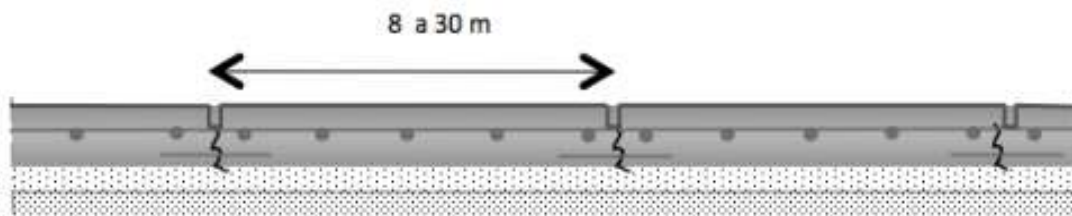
Pavimento de betão armado com juntas (elaboração própria – adaptado de Picado Santos et al, 2011)
